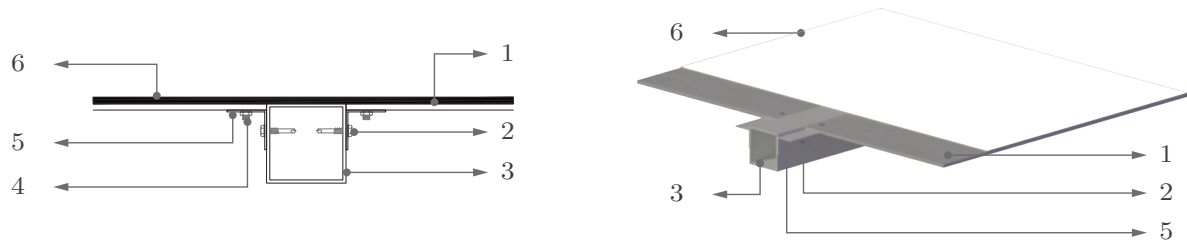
Sección constructiva en 3D del habitáculo Modular Emergency Plant. Fuente y elaboración: Autores.
